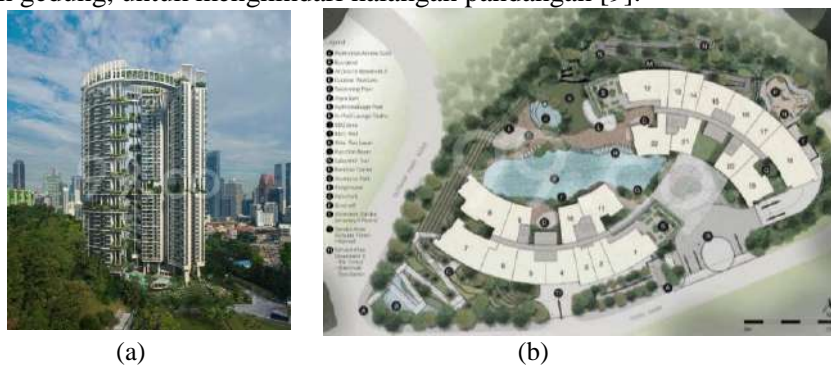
Sky Ville : (a) Gambaran Suasana Apartemen Sky Ville, (b) Site Plan Apartemen Sky Ville
